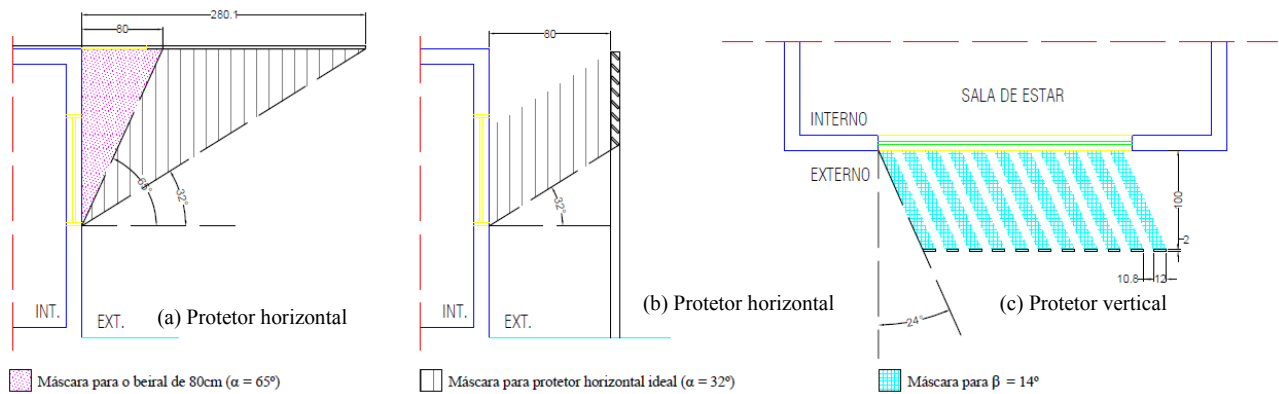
Protetores solares da fachada Sudeste. Fonte: elaborado pela autora
